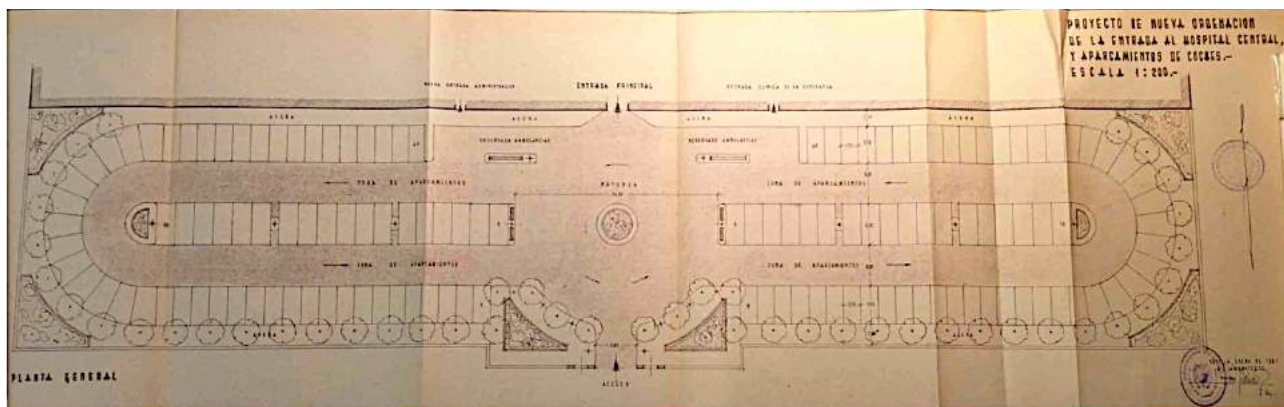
Planta de la lonja del Hospital Central. Entrada y aparcamiento, 1963.
